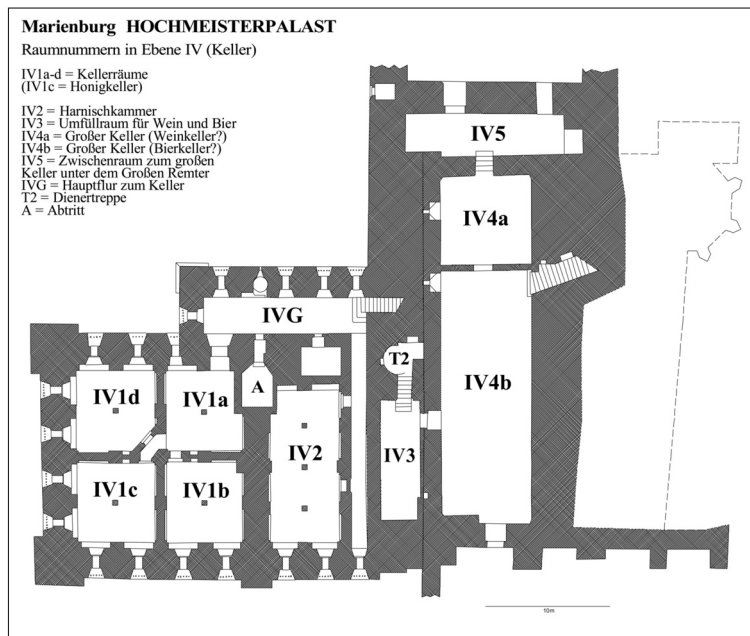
Grundriss von Ebene IV (Kellergeschoss) mit Angabe der Raumnutzung
